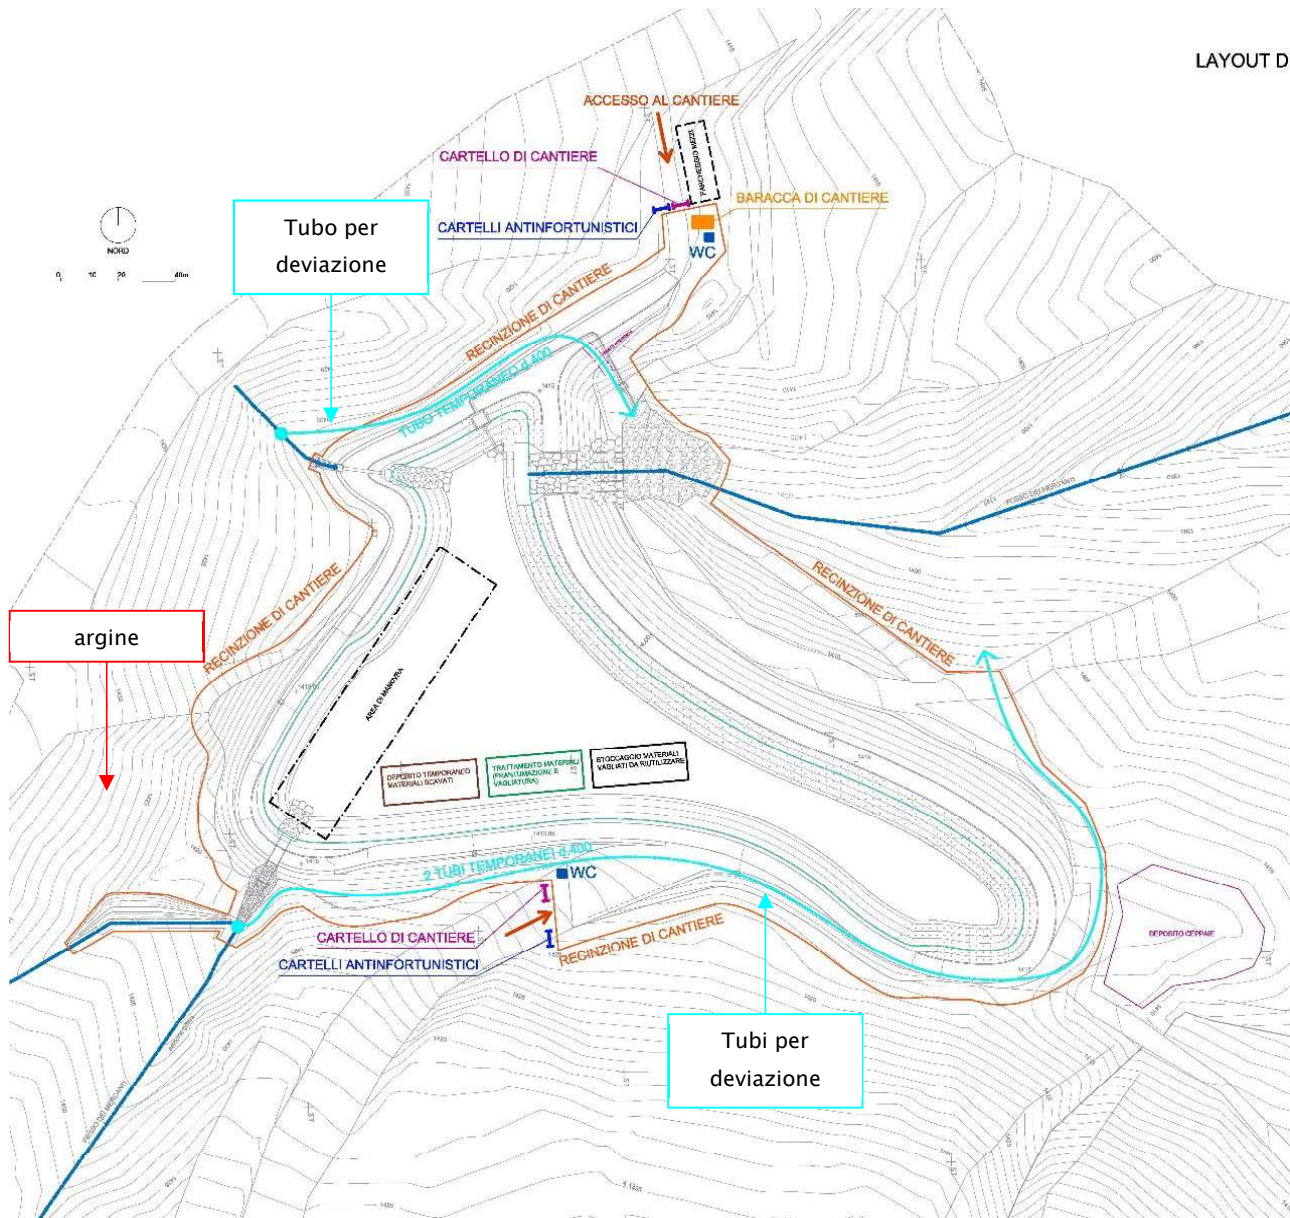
ESTRATTO LAYOUT DI CANTIERE CON DEVIATIONE TEMPORANEA FOSSI
